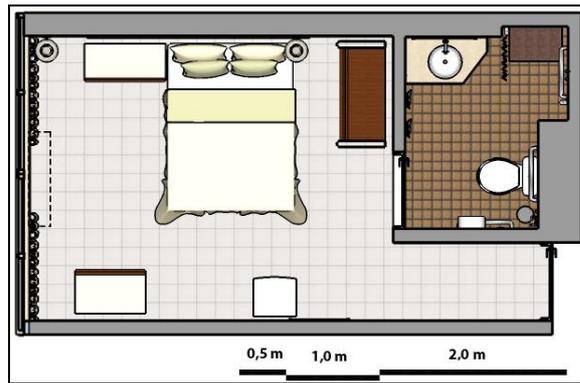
planta-baixa e layout do quarto adaptado do Hotel B
